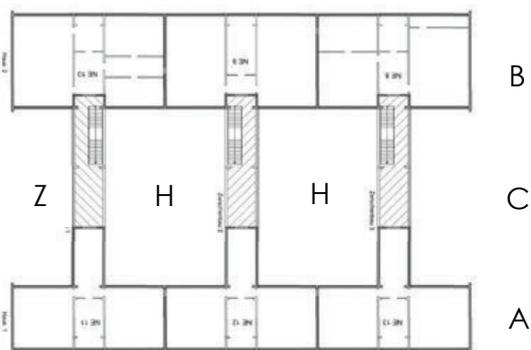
Systemgrundriss Obergeschoss (geplante Nutzungseinheiten)
